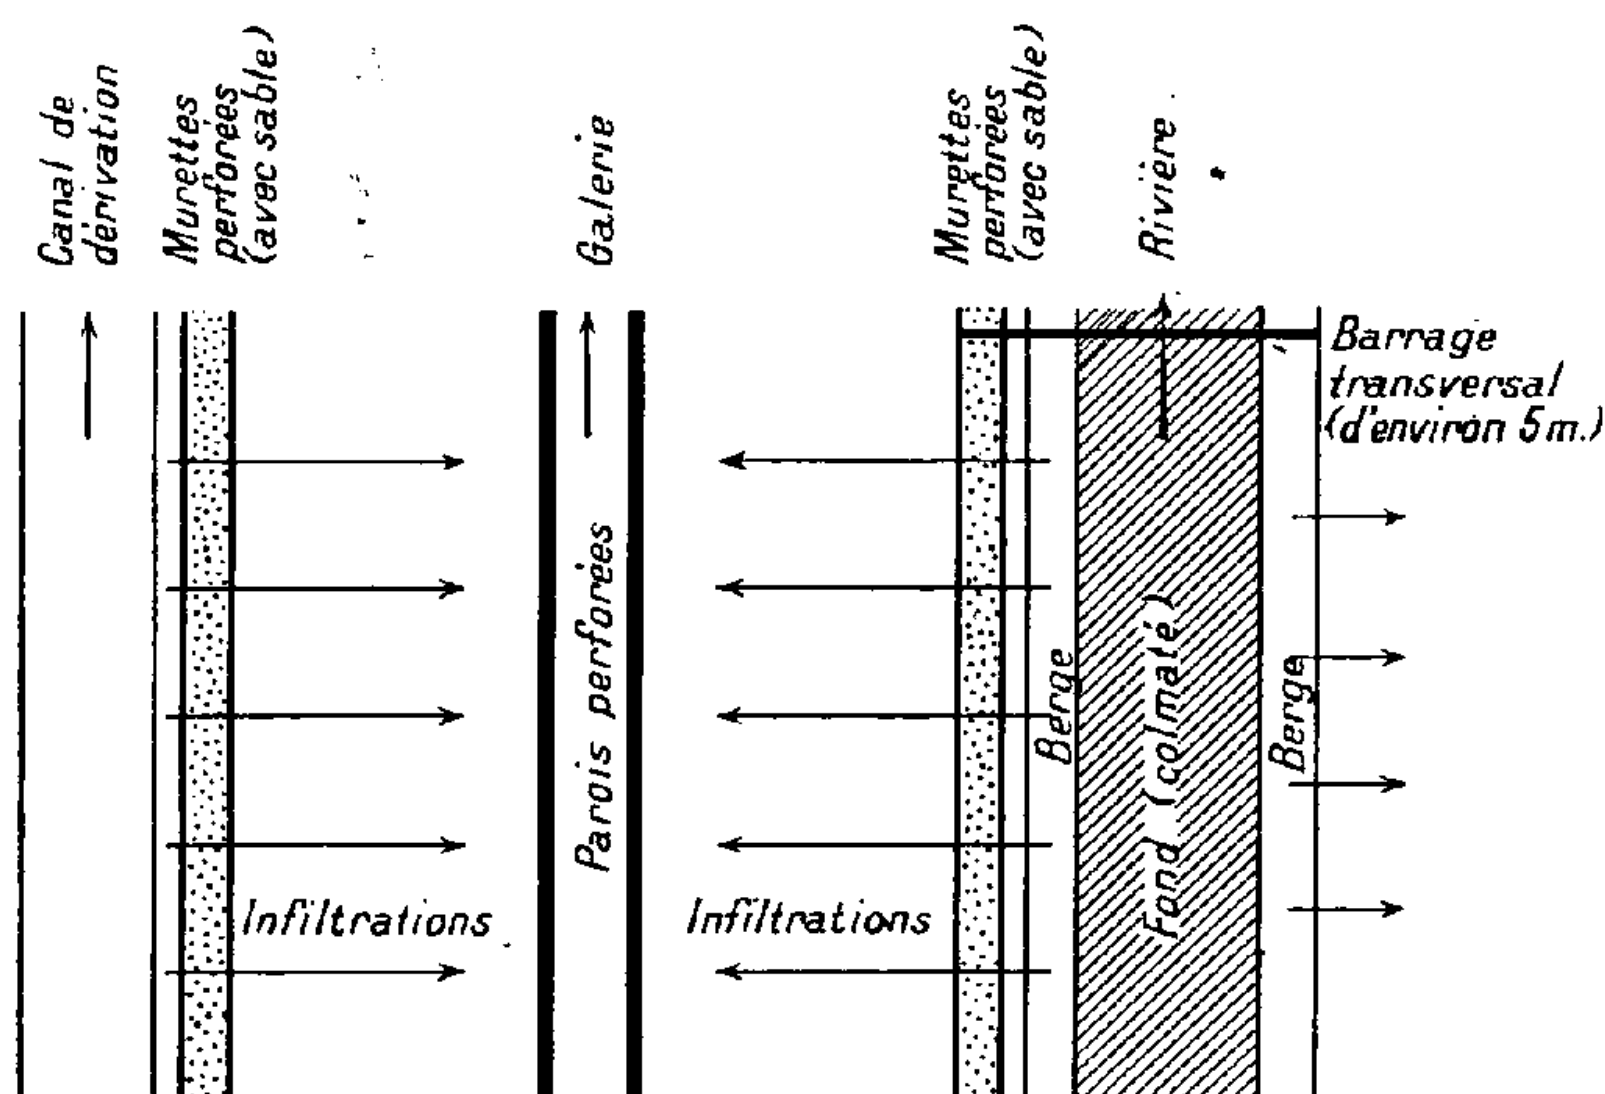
Plan (schématique) d'un tronçon de la vallée.
